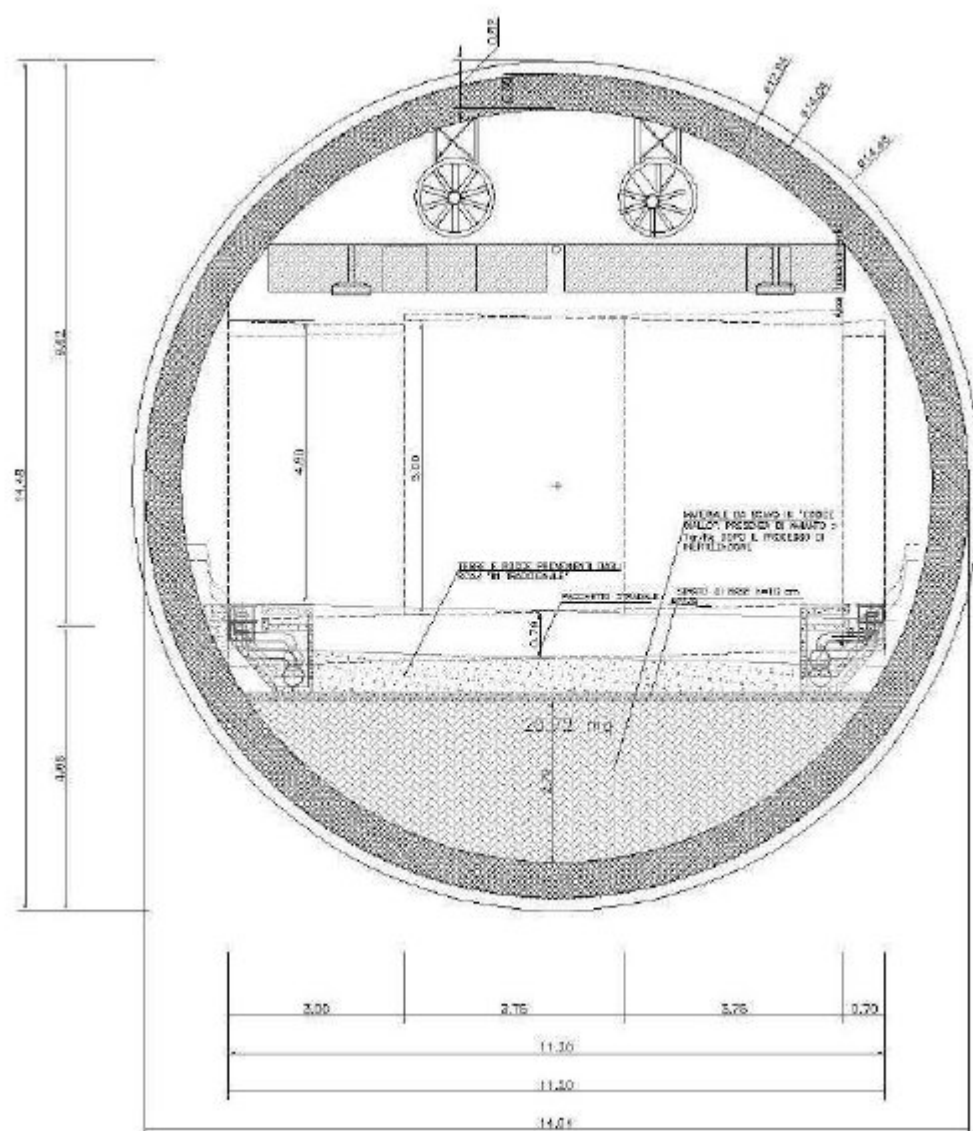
Sezione galleria tipo con scavo in meccanizzato
